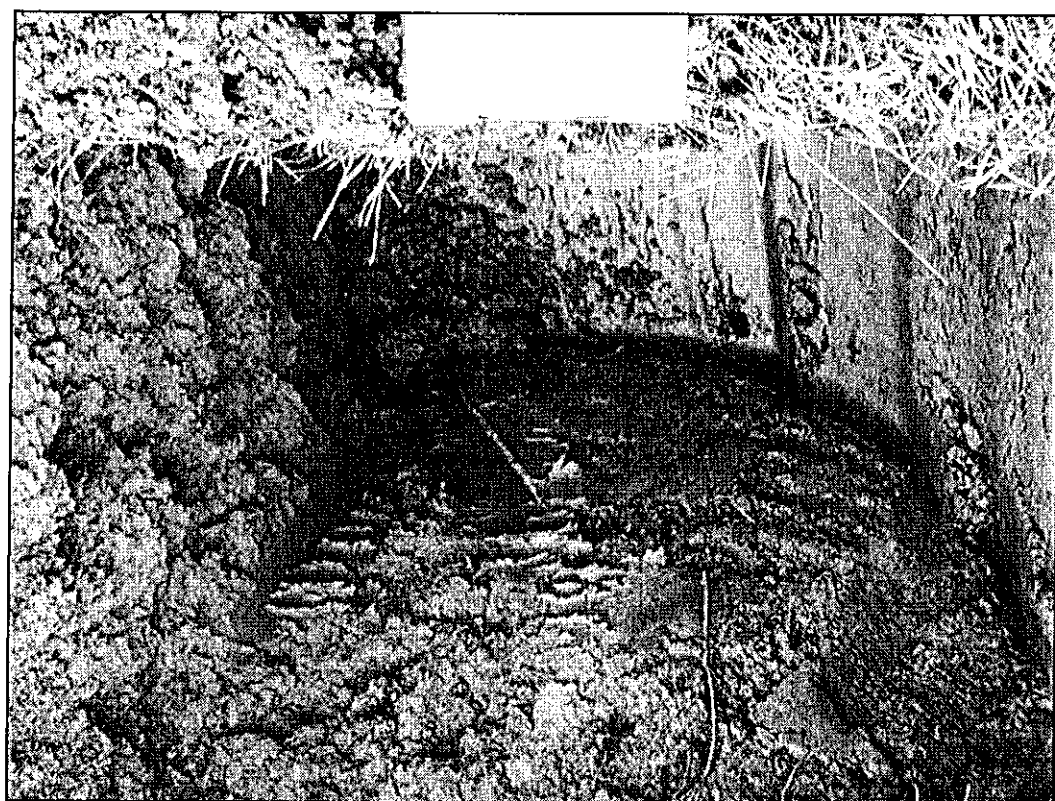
Pozzetto n° 11. Profondità -1.2 m dal p.c.
